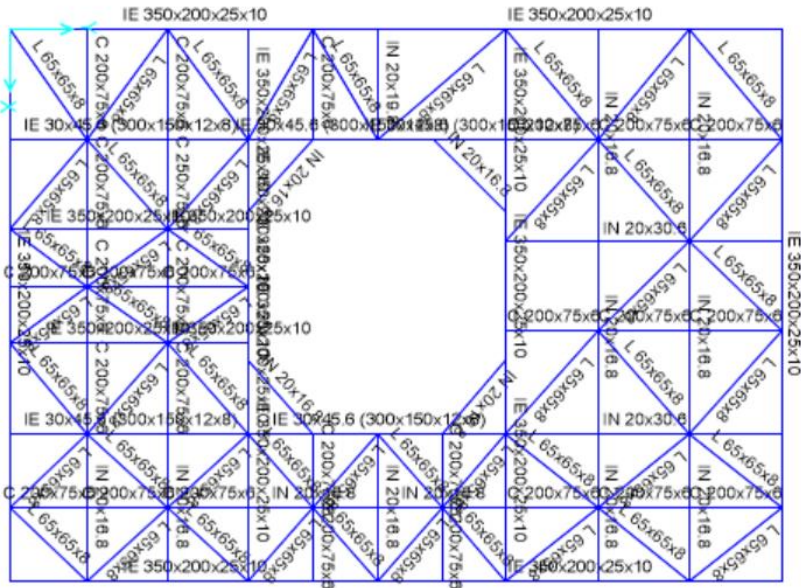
Vista en elevación 12.04 [m] sobre nivel de terreno.
